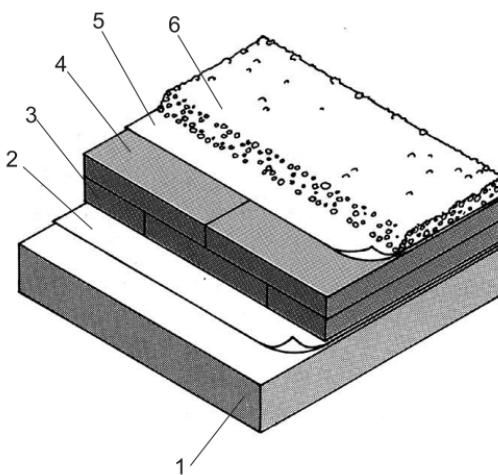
Утепление плоской крыши: 1 — железобетонная плита; 2 — подкровельная гидроизоляция; 3 — теплоизолирующие плиты; 4 — дополнительная теплоизоляция; 5 — подкровельная гидроизоляция; 6 — слой гравия
